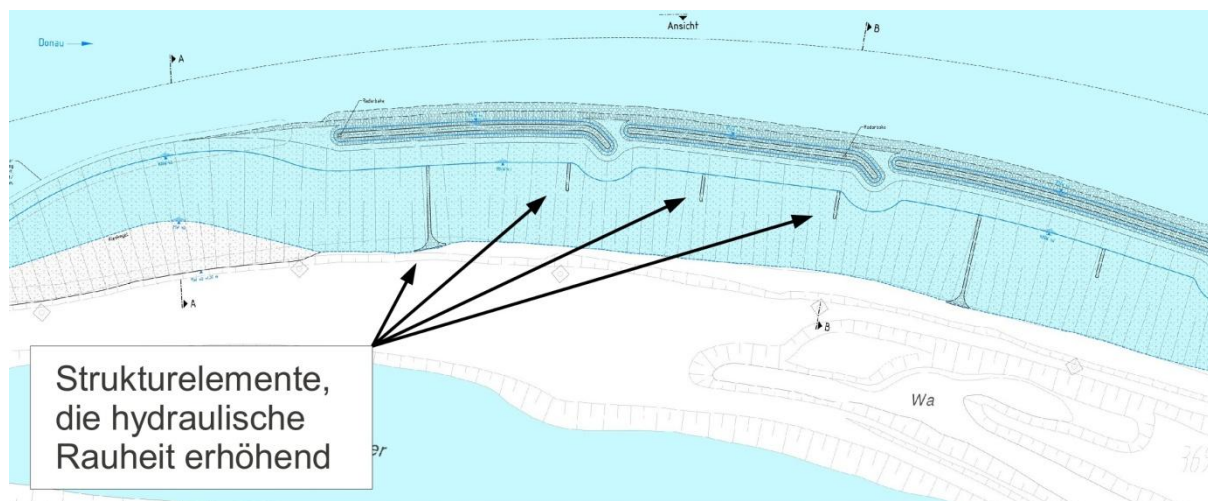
Lageplan-Ausschnitt aus technischem Plan Anlage II.01.72 (Uferverschüttung) mit Markierung der eingeplanten rauheitserhöhenden technischen Strukturelemente. Hierzu treten weitere hydraulisch raue Elemente wie z.B. Steinnester, Totholz u.ä.
